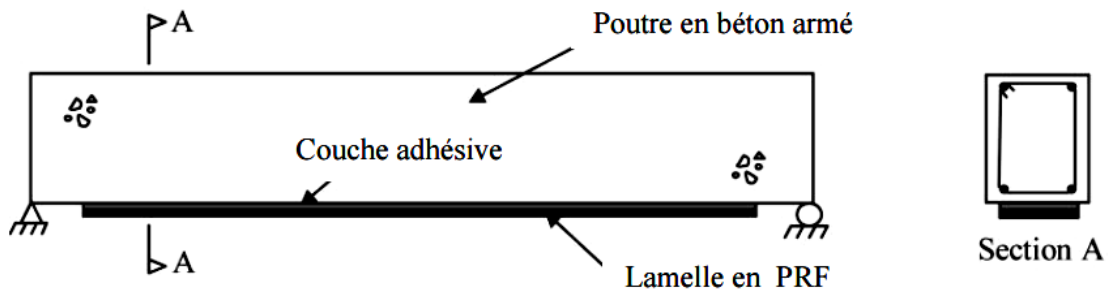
Une poutre en béton armé renforcée par une lamelle en PRF [60]
